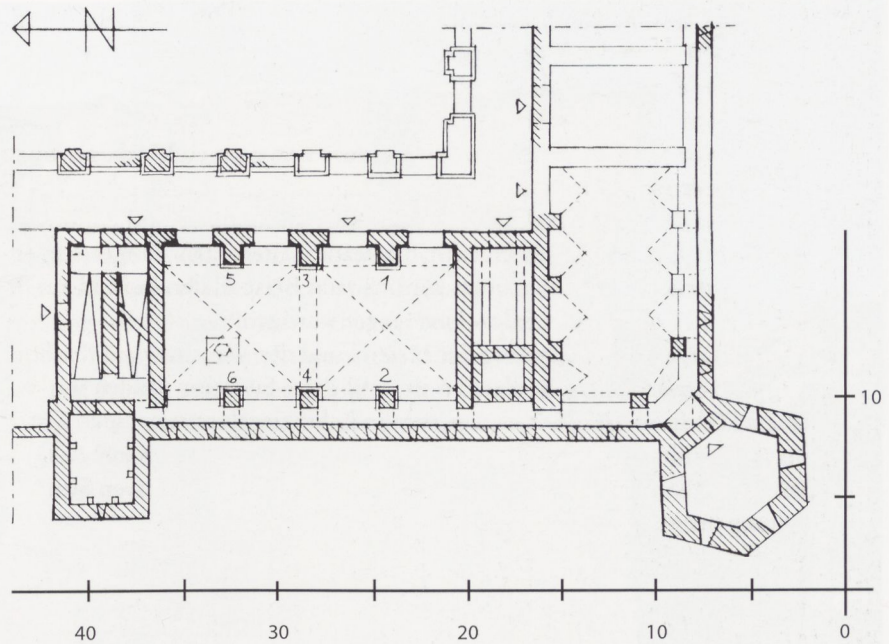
Androna. Kastron, Grundriss der Westhalle, Latrine, Südhalle und des süd-westlichen Eckturmes.
